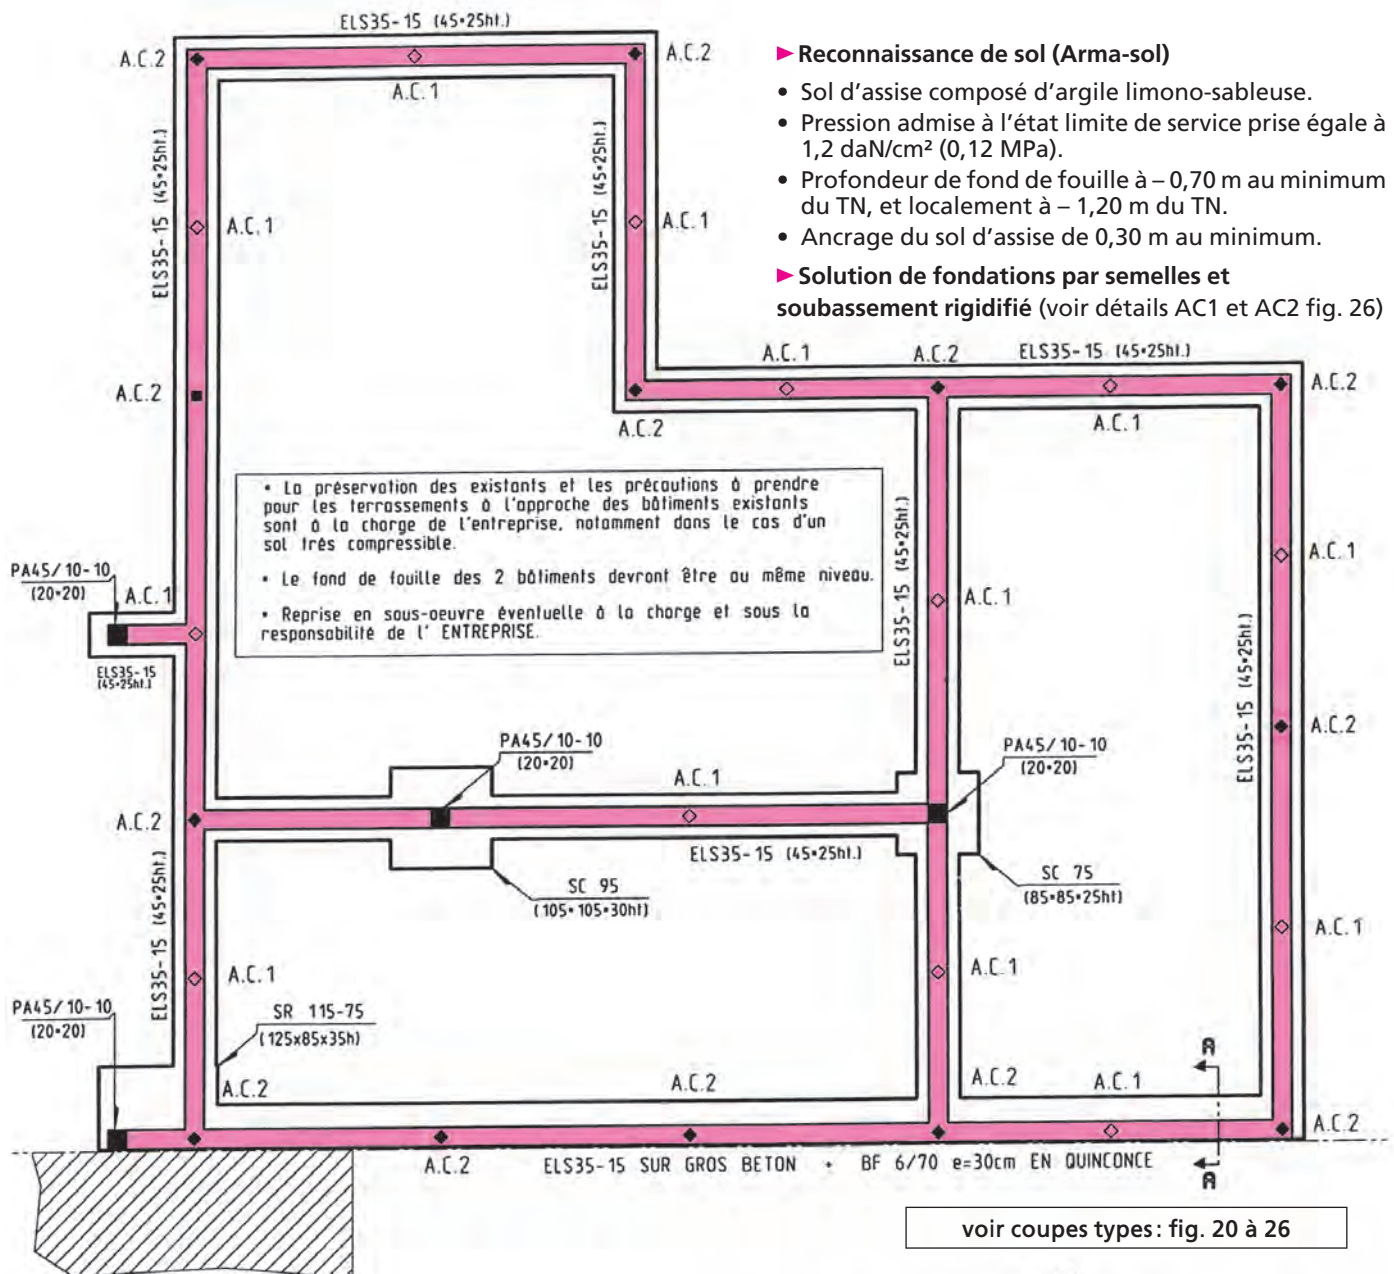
Vue en plan avec repérage des semelles filantes et isolées et attentes pour raidisseurs verticaux
